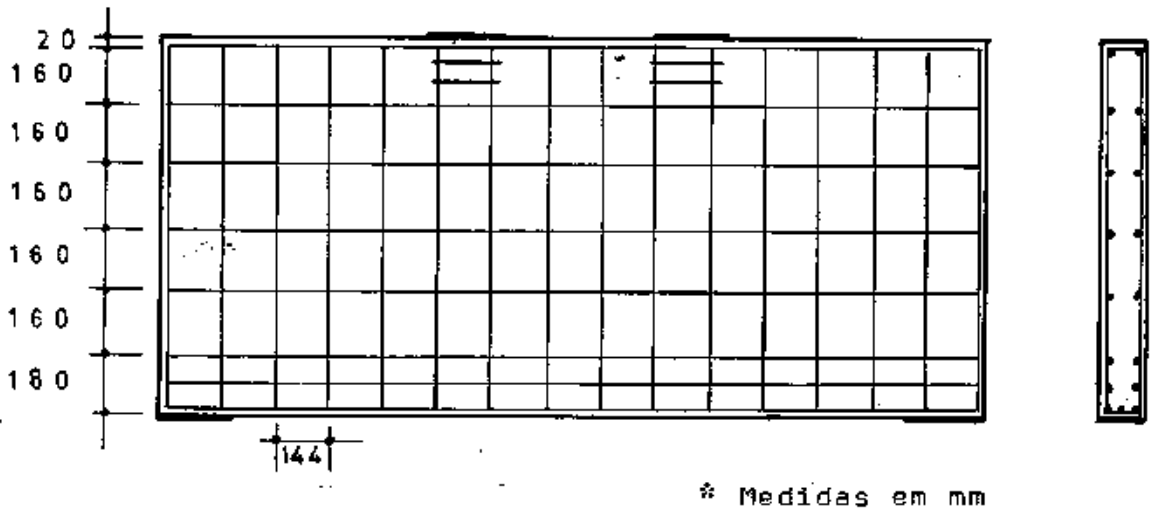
Armadura das vigas VT.1 e VP.3
